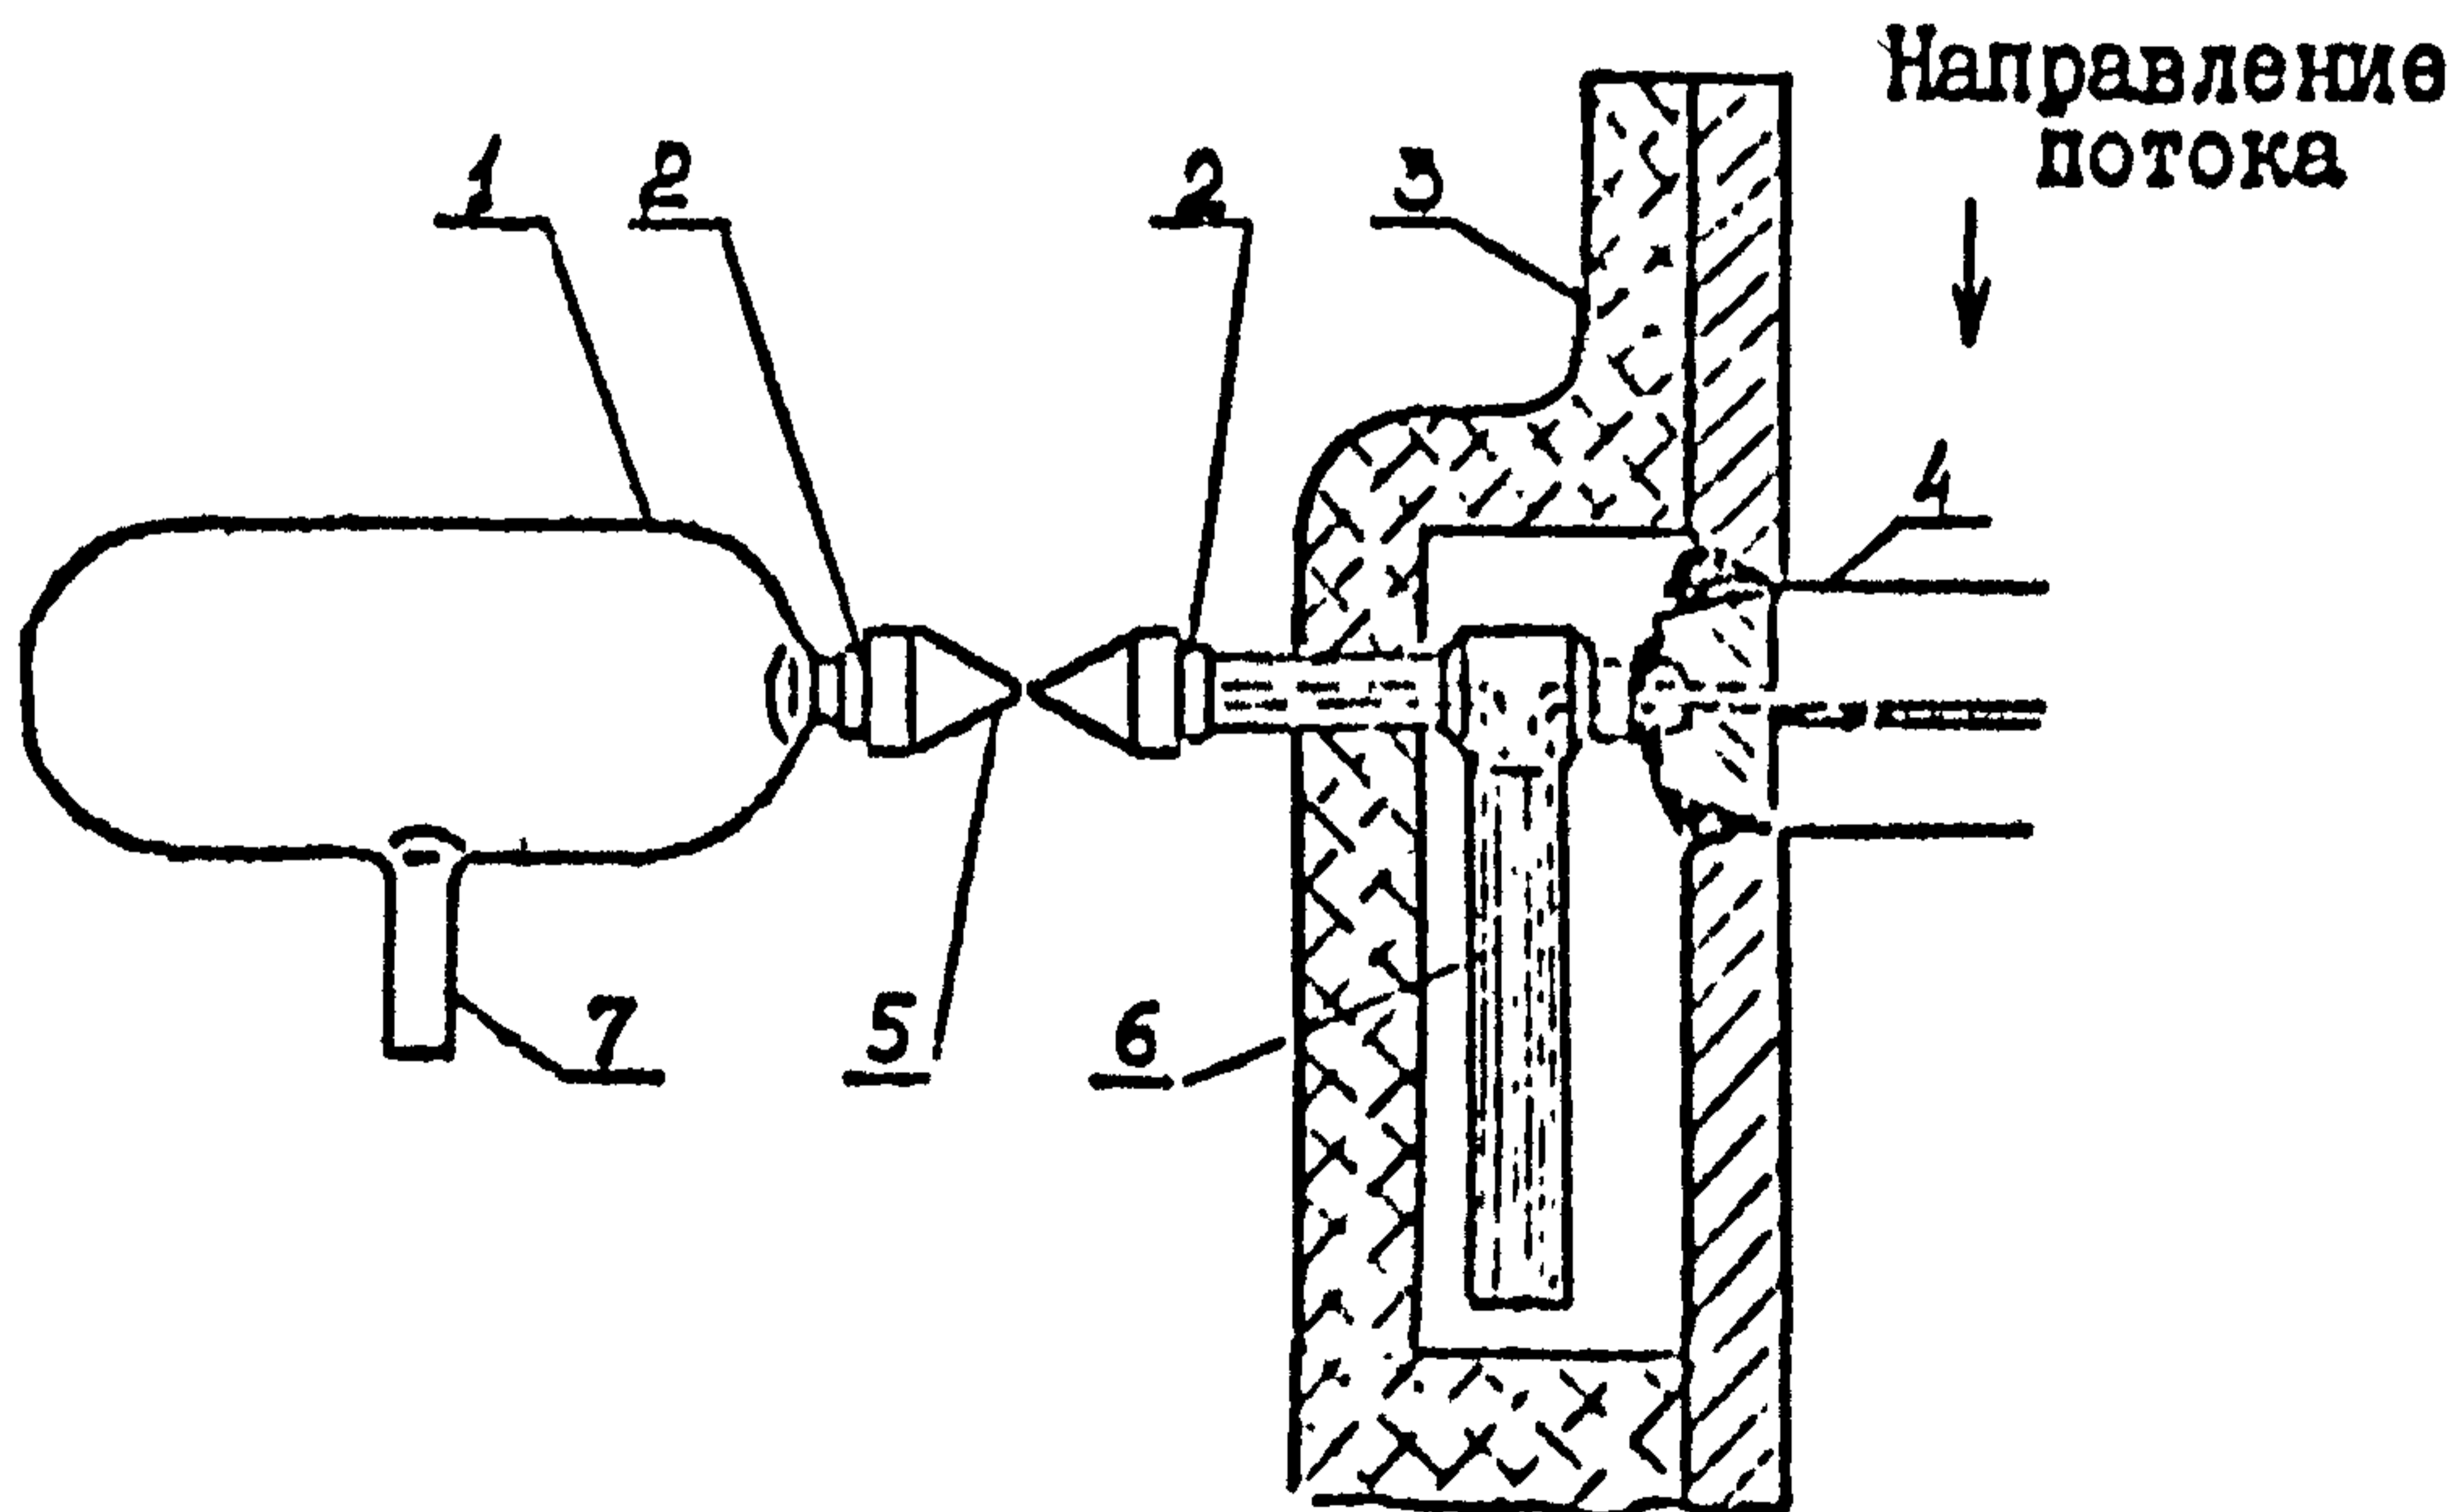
Монтаж аппаратуры для пара высокого давления и высокой температуры на вертикальном трубопроводе: 1-конденсационный сосуд; 2-сварные соединения; 3-изоляция; 4-сужающее устройство; 5-кран; 6-ловушка; 7-соединительная труба
